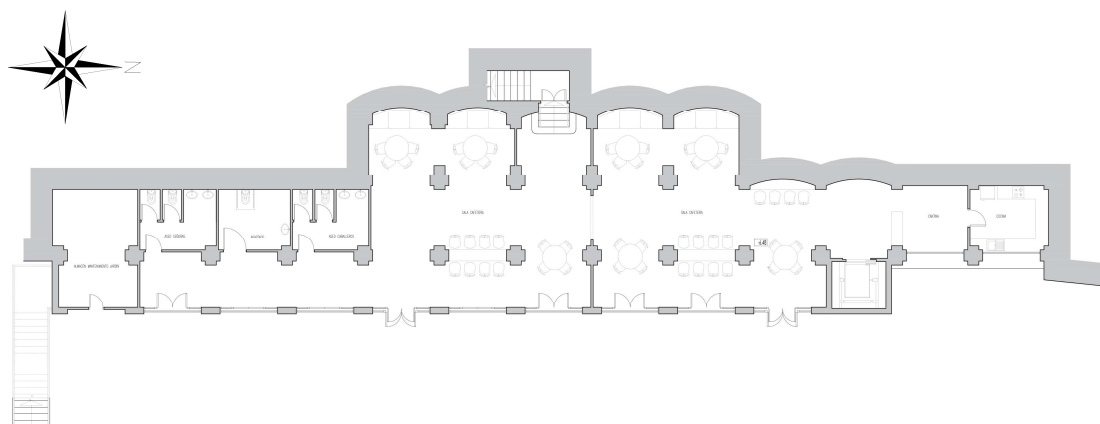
Nueva distribución Planta Sótano -2 Volumen 2. Fuente: Elaboración propia.
